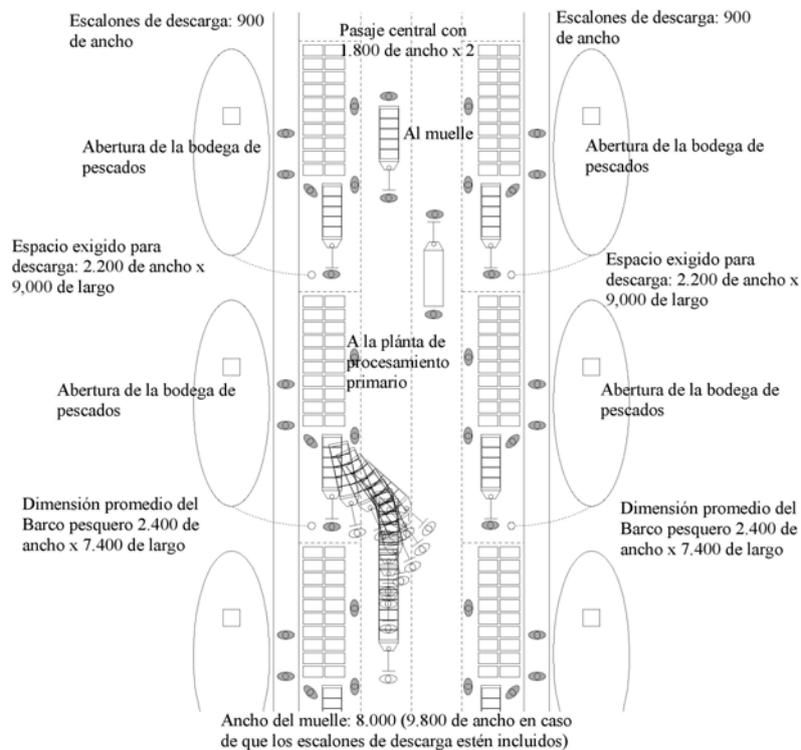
Plano del Proyecto para Utilizar el Muelle
